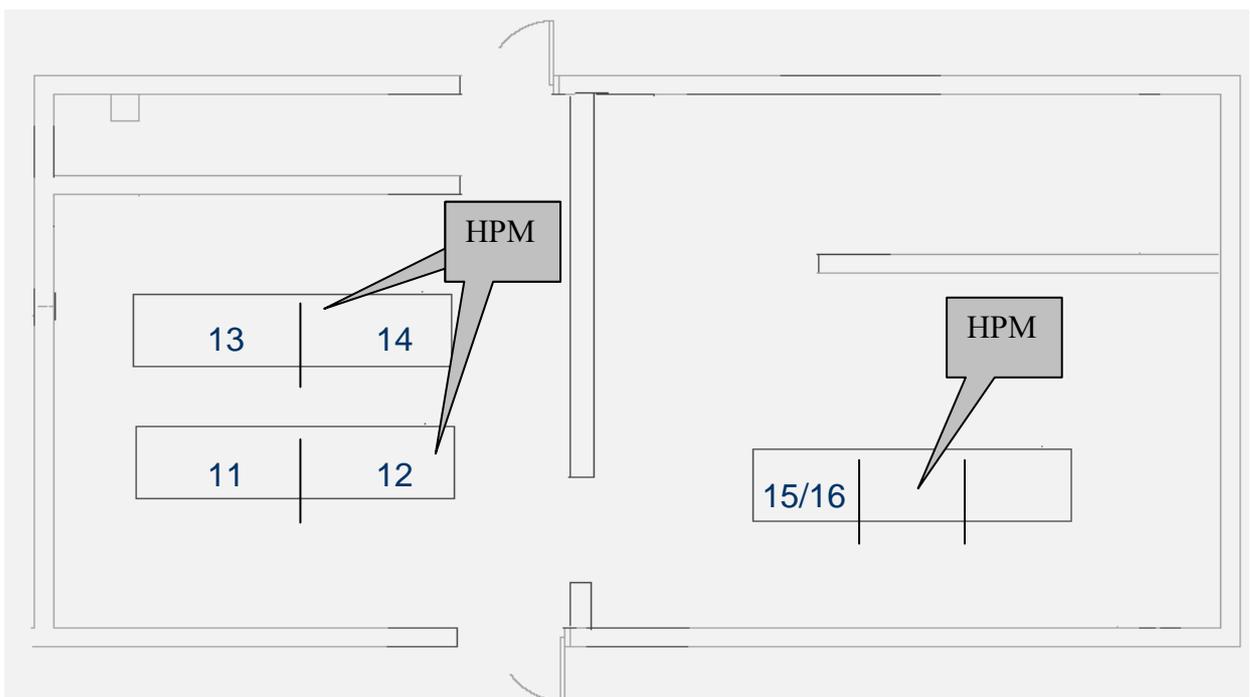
Ubicación de los HPM en caseta planta de Oxigenados. Fuente propia.
